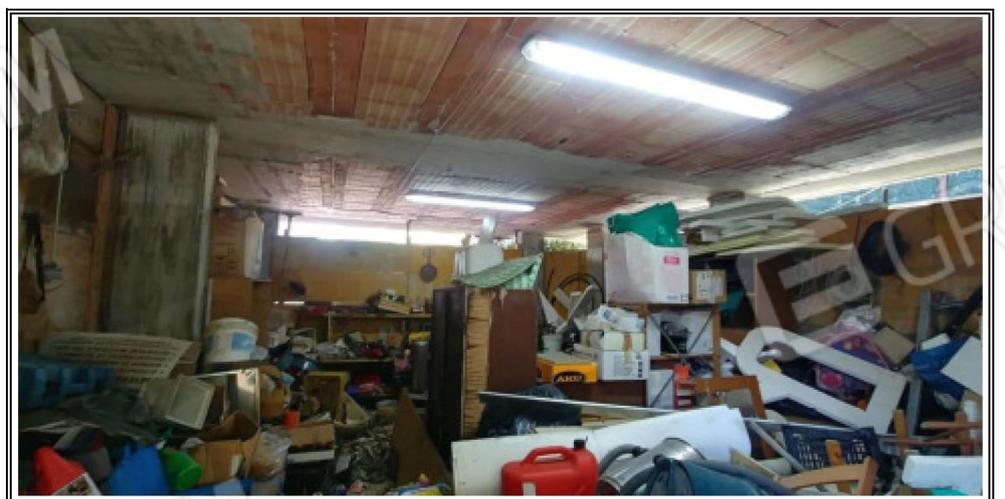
Manufatto ad uso magazzino – Piano terra
